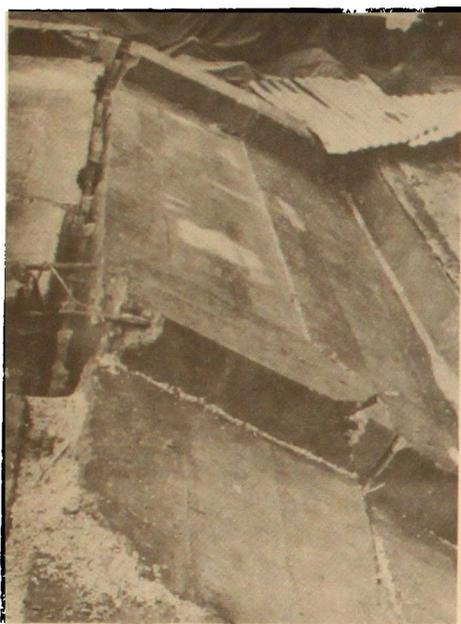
Muro volcado perteneciente a un galpón en Gorbea. La fractura revela la debilidad de la junta
